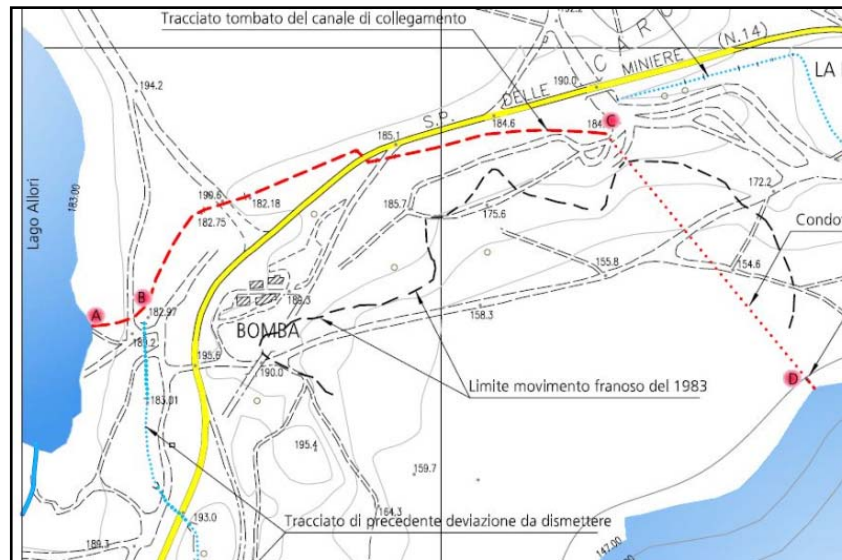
PLANIMETRIA CANALE SCARICO MINICENTRALE (FIG. 1, MAG. 2006)
